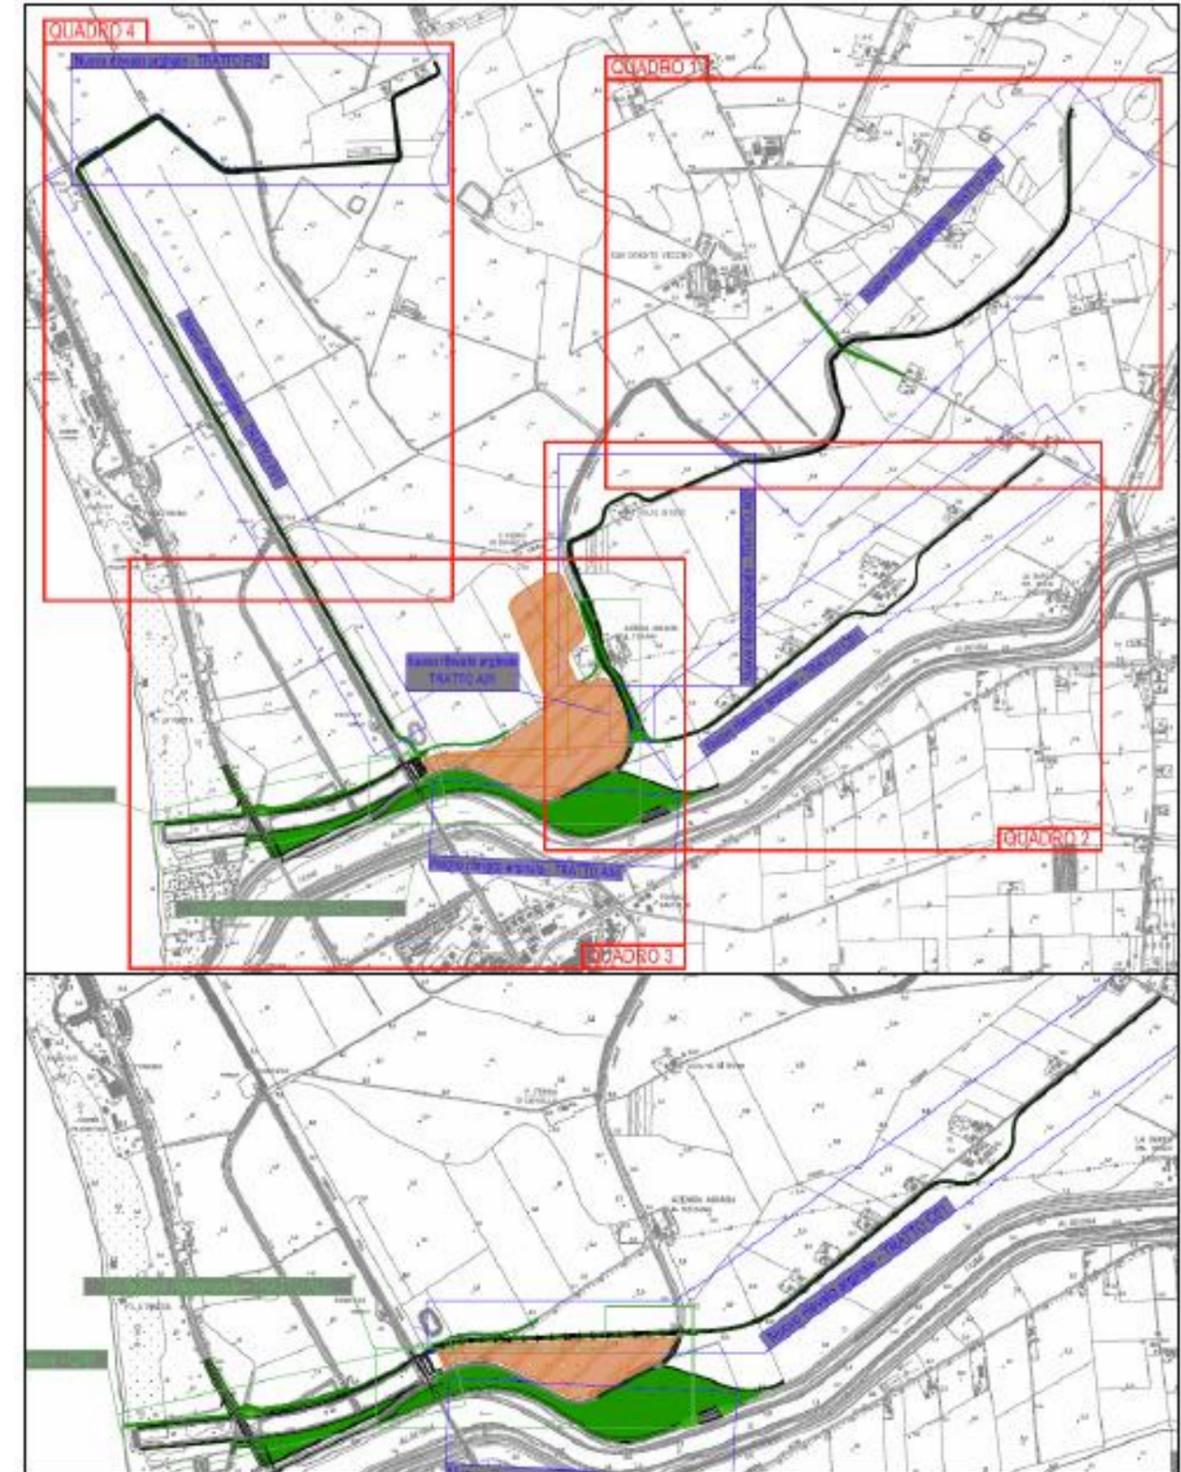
Planimetria di progetto della Cassa d’Espansione e del Canale Scolmatore.
